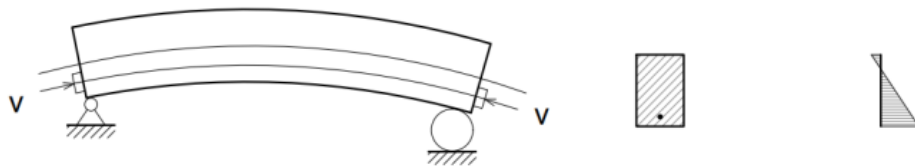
Aplicación de las cargas en el hormigón pretensado [34]
